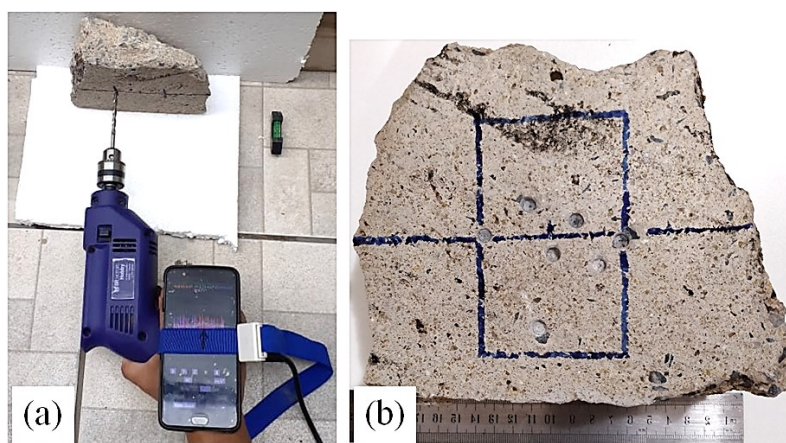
Ensaio de furação no concreto. (a) posicionamento para realização do ensaio. (b) material perfurado. Fonte: autor.
